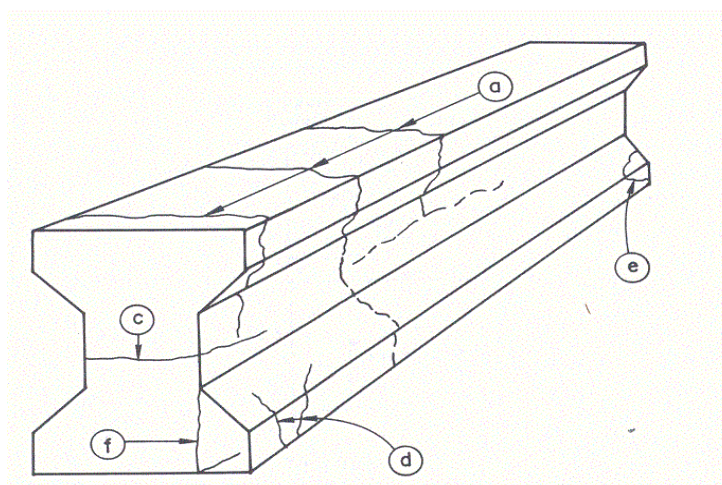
Fisuras en la fabricación, transporte y manejo de miembros de concreto reforzado o preesforzado.
